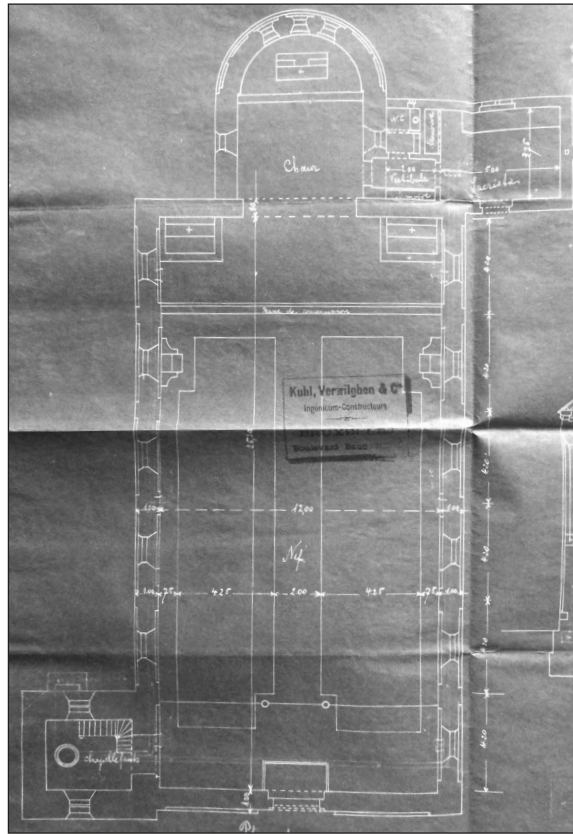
Second projet d’Auguste Van Assche, plan.
